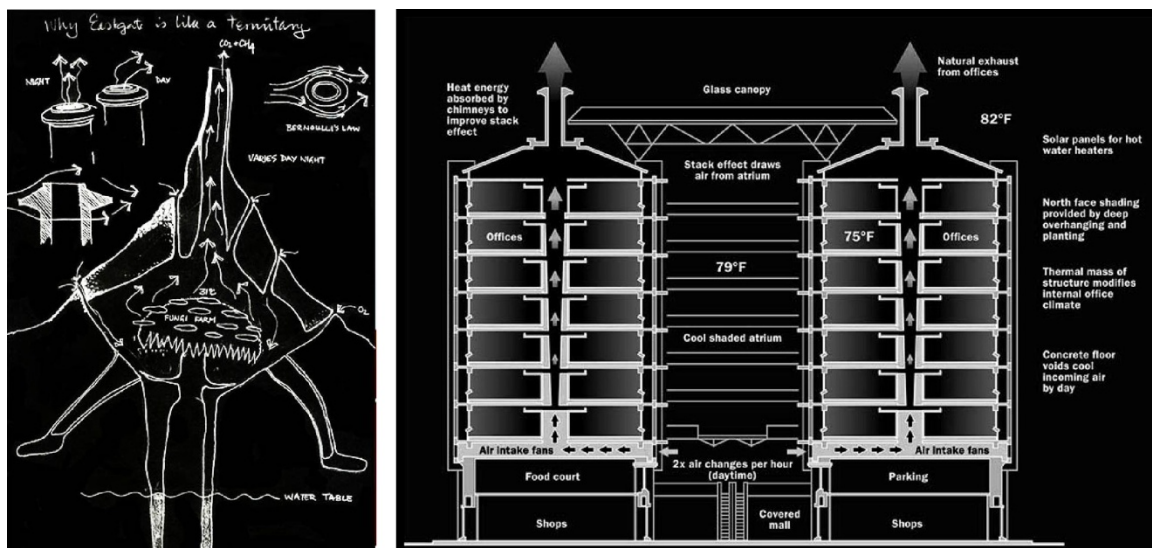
Confronto tra sezione ipogea e sezione del Eastgate building - Progetto Pearce Architects, Harare (Zimbabwe)
